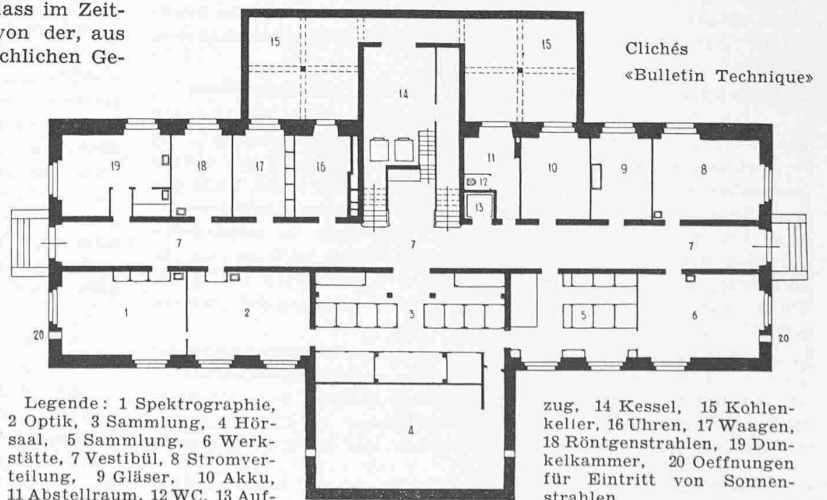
Grundriss vom Untergeschoss des Uhren-Laboratoriums Neuenburg. — 1:400
